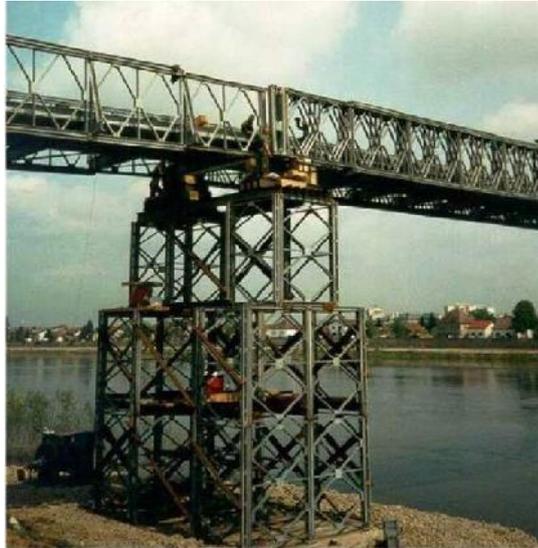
Pilares de apoyo de puente modular, conformados por paneles
